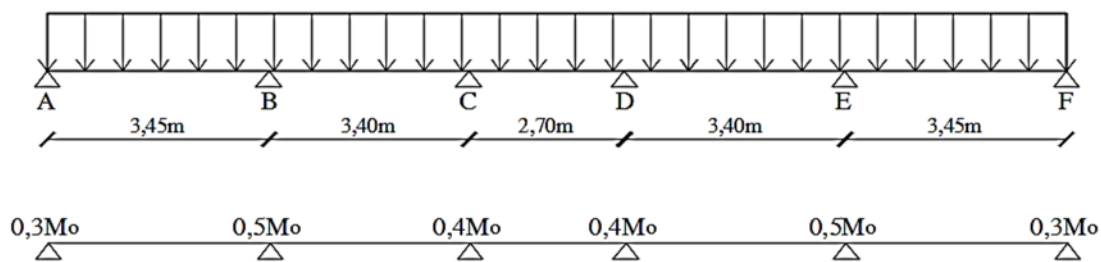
Schéma statique de la poutrelle à plusieurs travées de la poutre « I »
